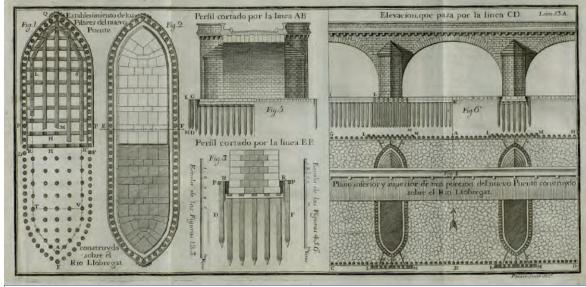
Recintos tablestacados y pilotes hincados de madera en la construcción de pilas en el cauce del río Llobregat (puente de Molins de Rei. Tratado de Sánchez Taramas
